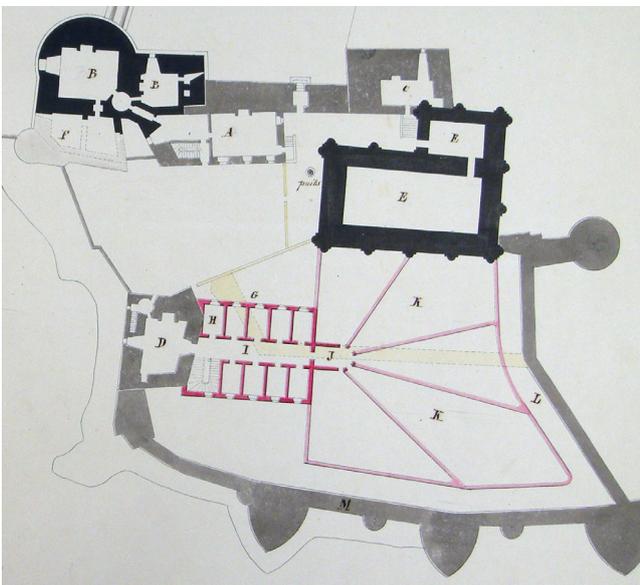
plan de 1839 de A. Pescherard (ADIL 4N99) projet de construction de nouvelles prisons
